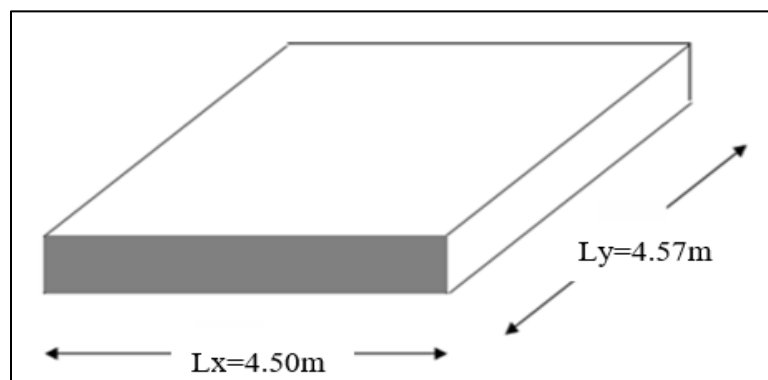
La section de plus grand Panneau de la dalle pleine
